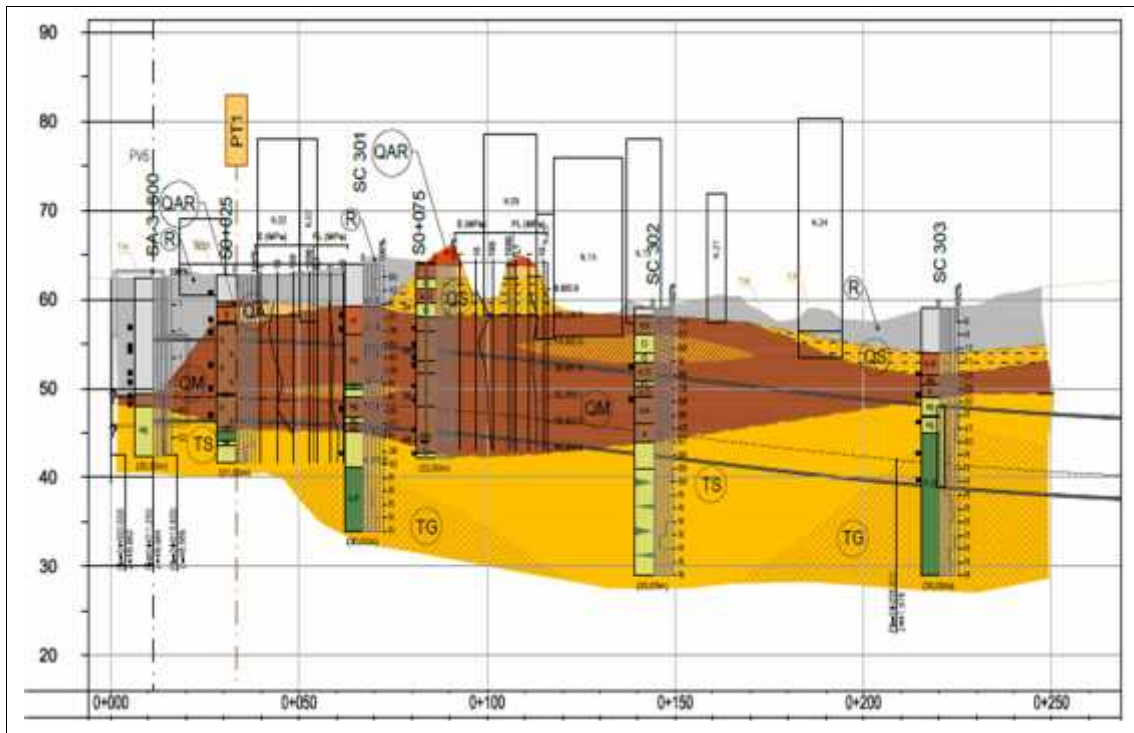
profil géologique longitudinal d'une section du tunnel.
